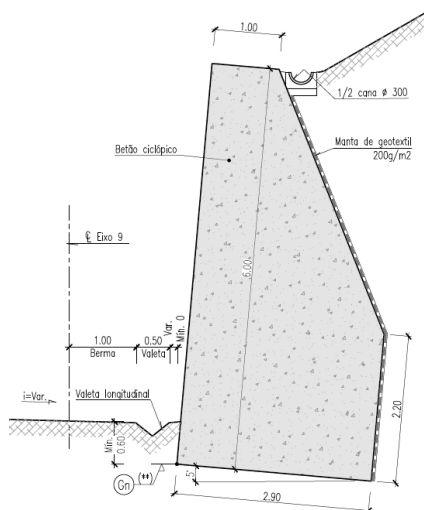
Corte transversal tipo do muro M2 (Muro em Betão Ciclópico).
